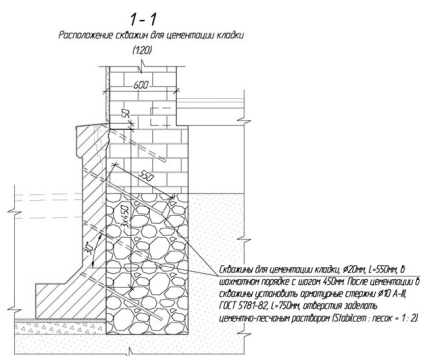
Узел сопряжения железобетонной конструкции уширения бутовых ленточных фундаментов (разработана подрядчиком)
